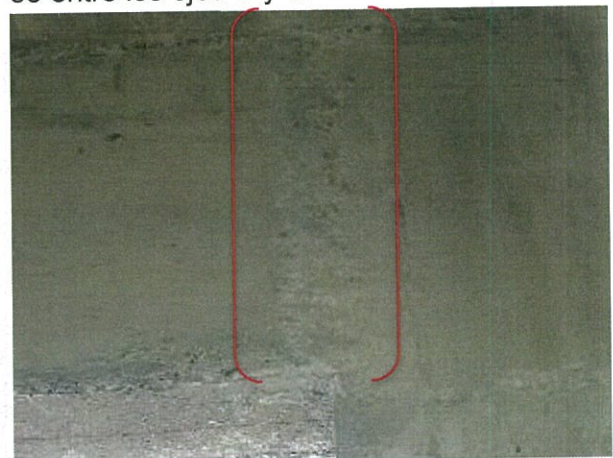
, 03-07-2015, juntas de construcción mal ejecutadas en muro de eje 31 con intersección eje R2.
